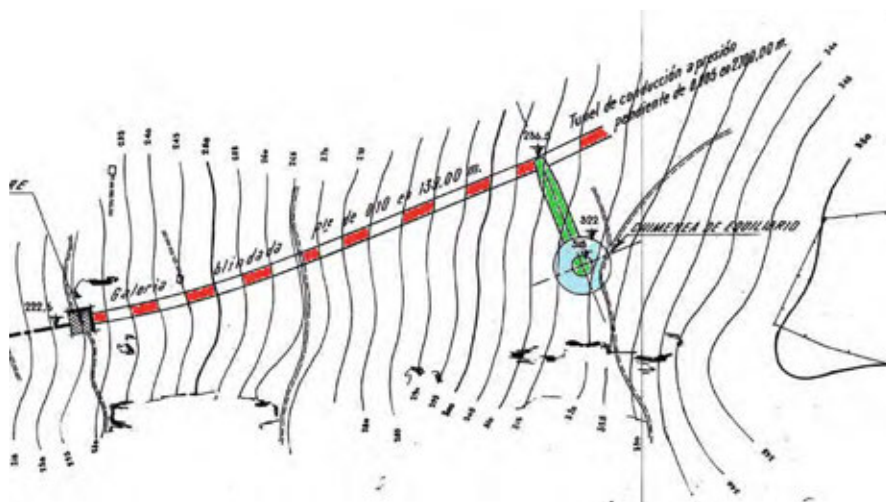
Planta de la chimenea de equilibrio. E308.1 ADF.
